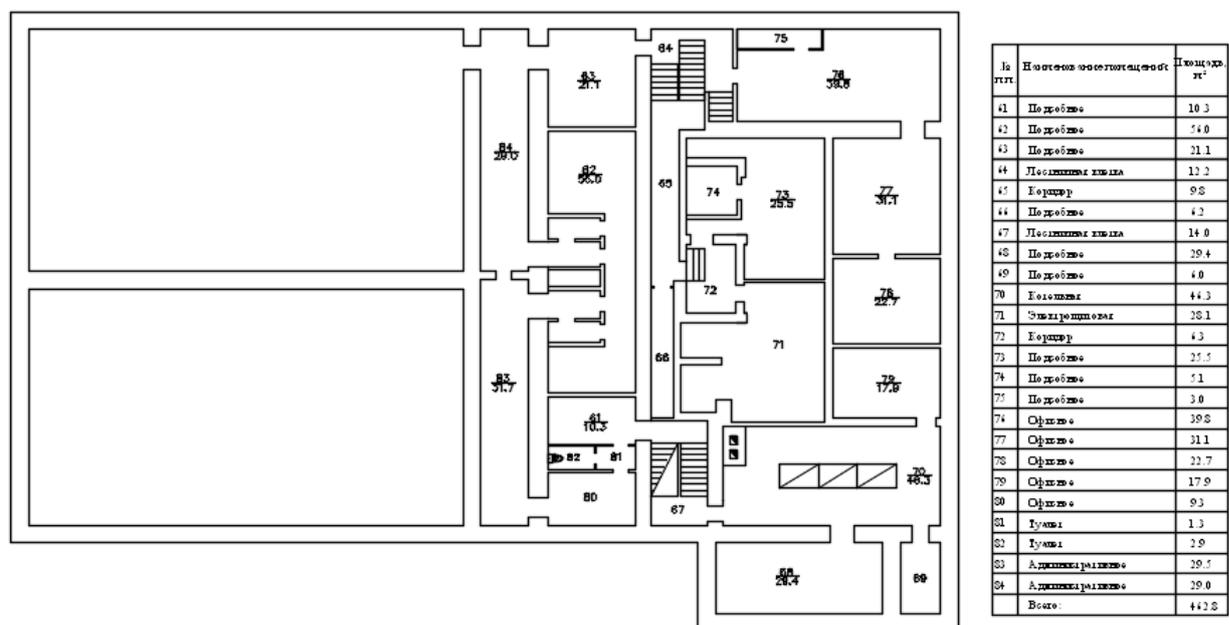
План помещений цокольного этажа АДЦ со спецификацией помещений
